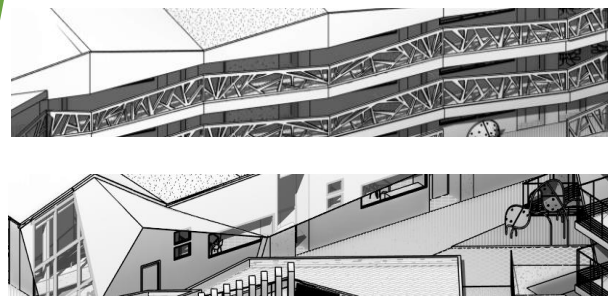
VOLADIZOS Y MEMBRANA EN LAS FACHADAS NORTE Y SUR
